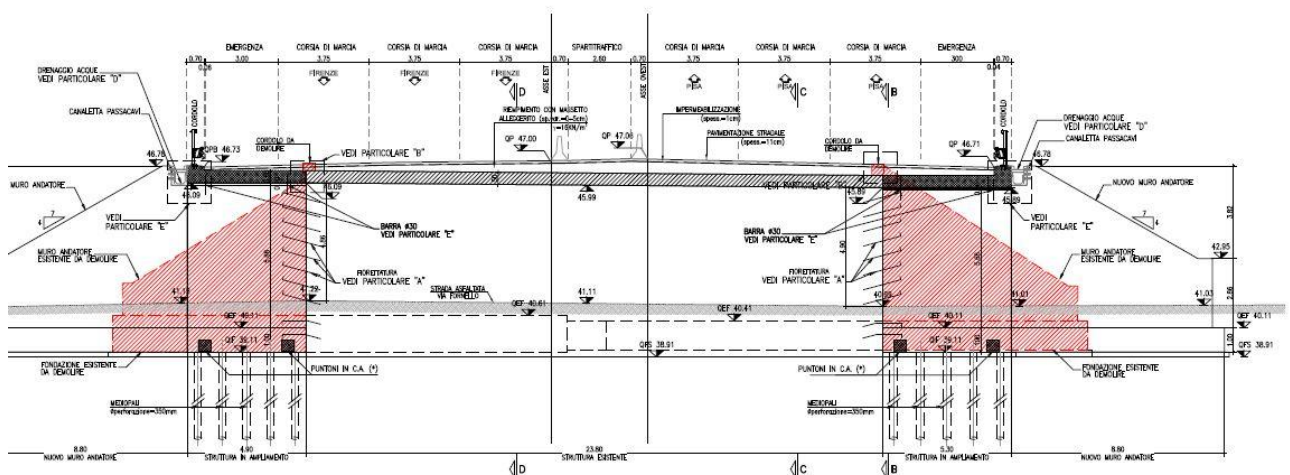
Sezioni tipo progetto ampliamento sottovia.
